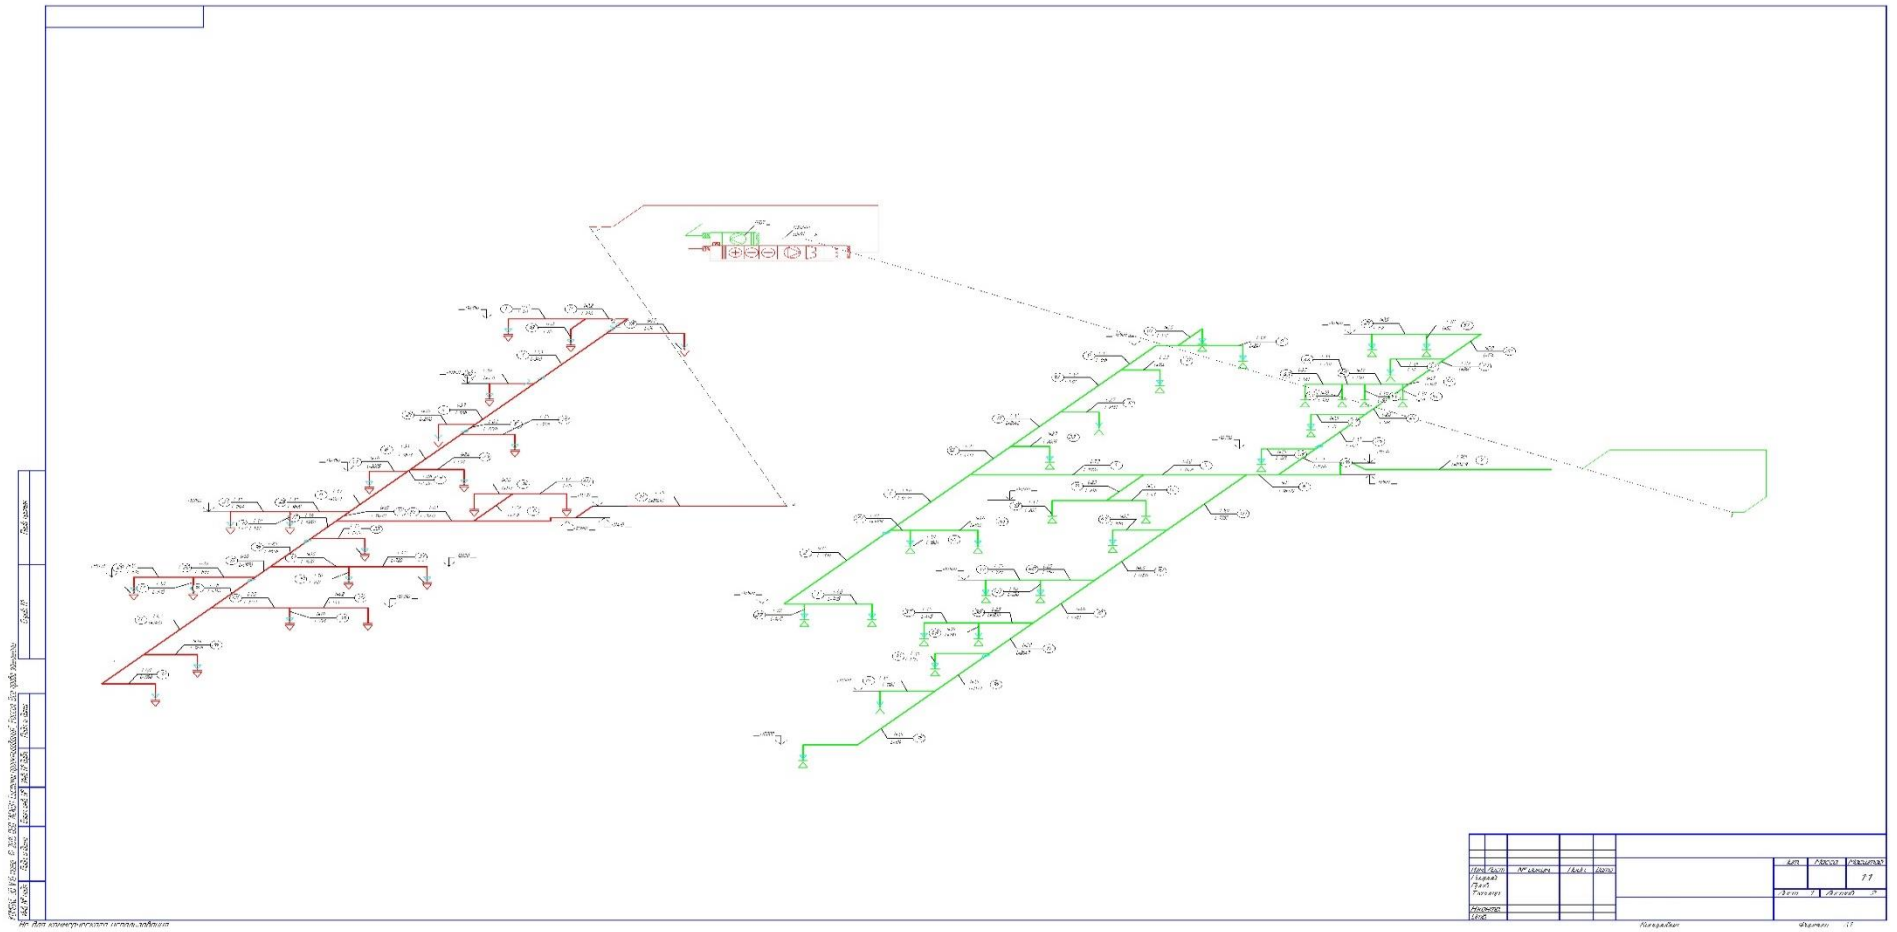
Расчетная схема системы вентиляции П2В2
